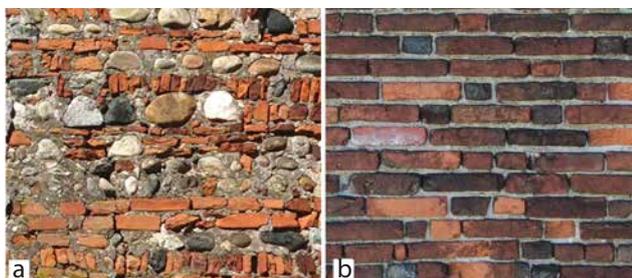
S. Genuario di Lucedio. Dettaglio di murature del complesso: testata est, XI secolo (a) (foto F. Pondrano); campanile, prospetto ovest, XIV-XV secolo (b) (foto A. Vecco).
